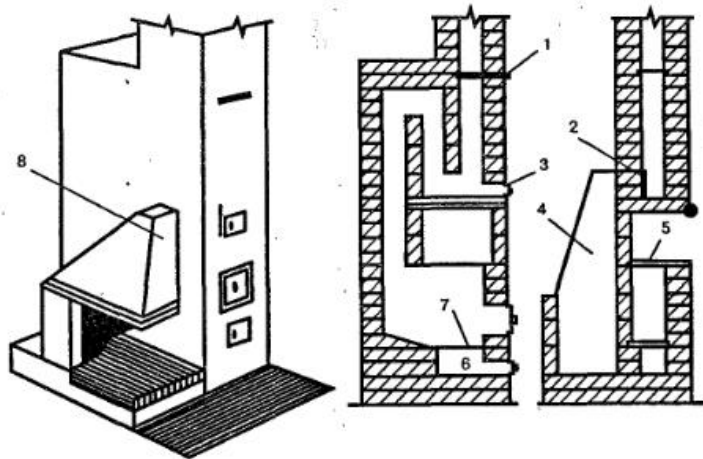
Печь-камин со стальным колпаком. Общий вид и разрезы. 1 — задвижка печи; 2 — задвижка камина; 3 — чистка; 4 — каменный колпак-дымоход; 5 — чугунный настил; 6 — зольник; 7 — колосниковая решетка; 8 — стальной колпак
